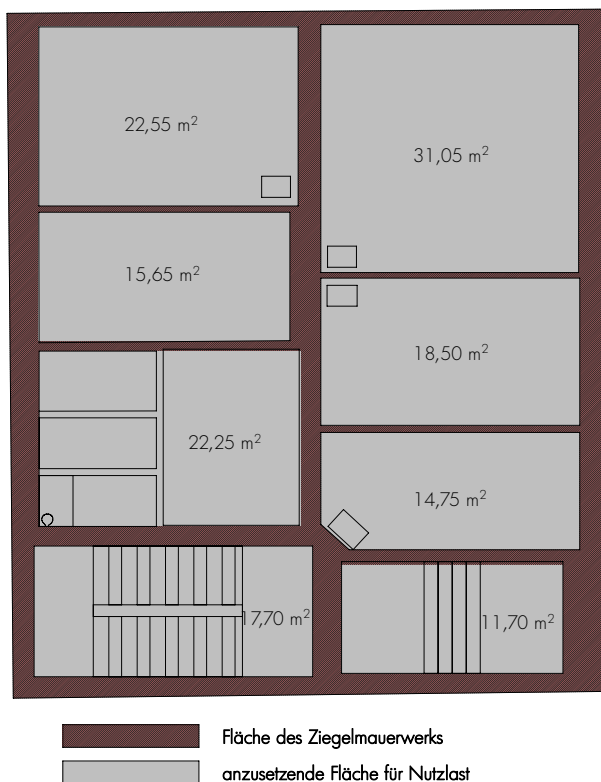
Grundriss der bestehenden Geschoße - Gründerzeitobjekt
